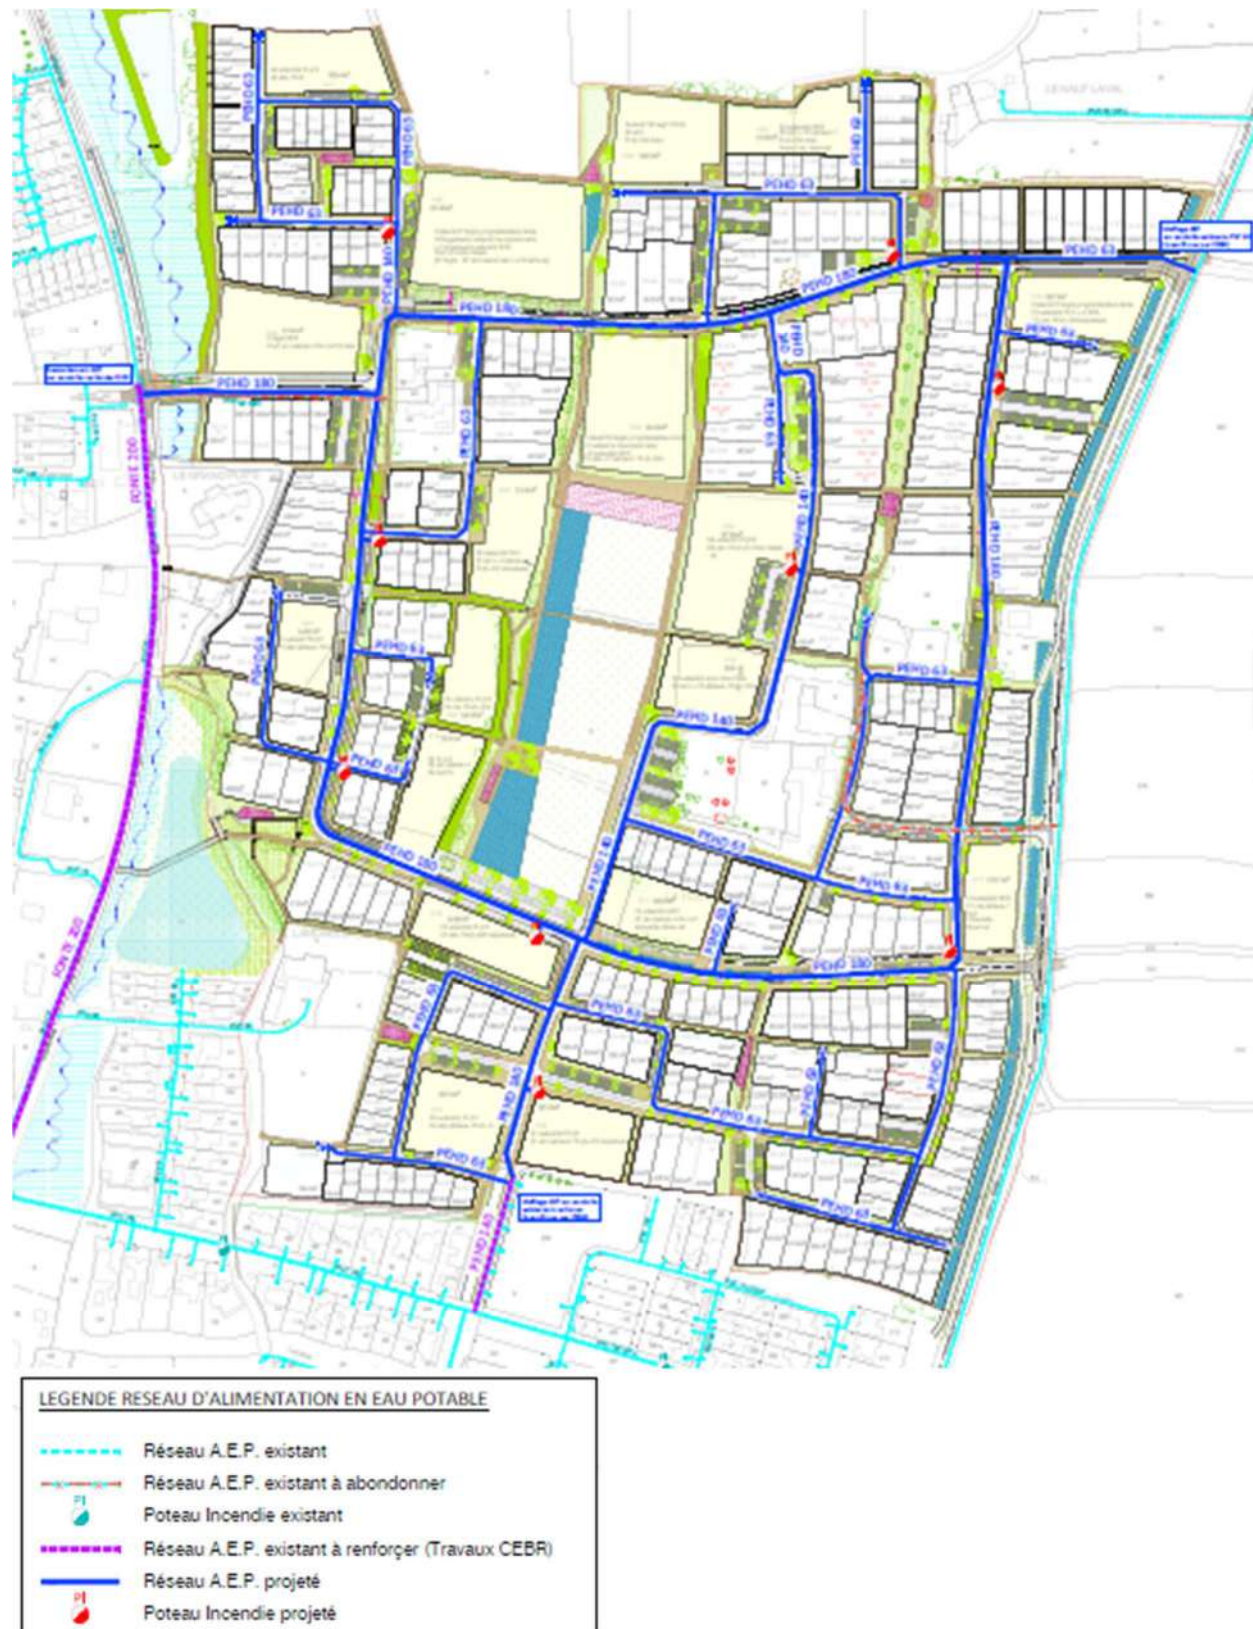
plan du réseau d'alimentation en eau potable, secteur Touraudière - Stade AVP
